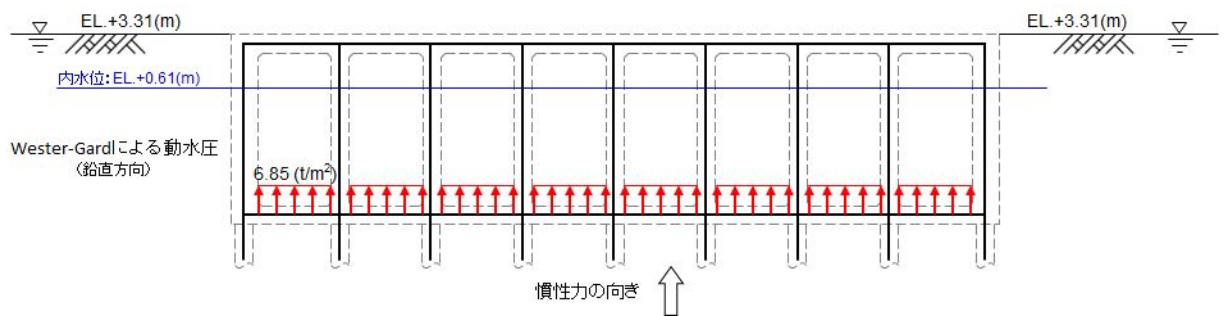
(2) 鉛直動による動水圧図 (①-①断面)
